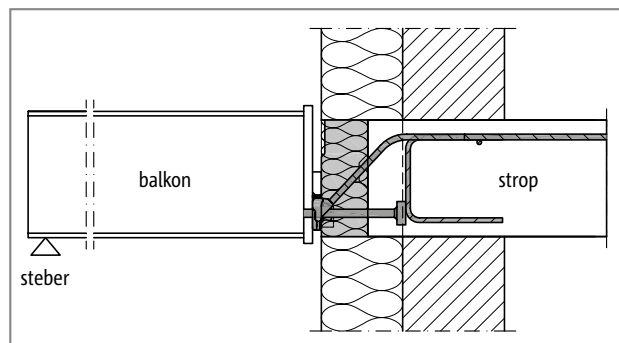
Schöck Isokorb® T tip SQP: priključek na železobetonski strop; monolitna konstrukcija stene
